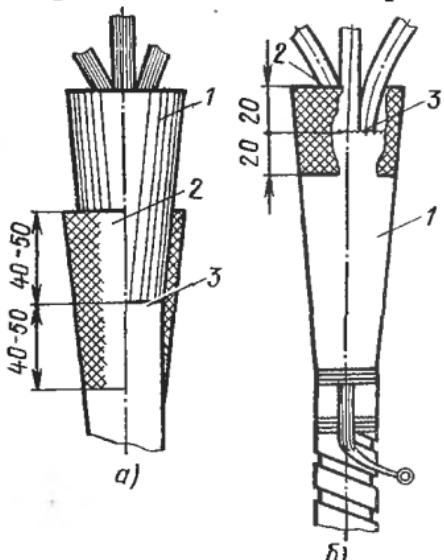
Установка ремонтной формы для устранения течи пропитывающего состава в местах ввода кабеля в корпус заделки (а) и вывода жил из корпуса (б):
